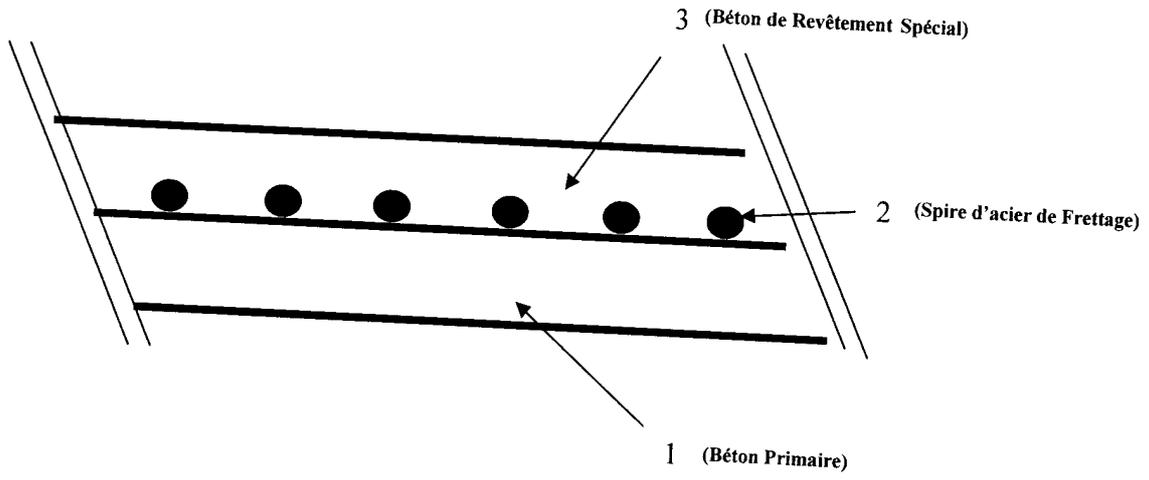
COUPE LONGITUDINALE D'UN TUYAU HD
